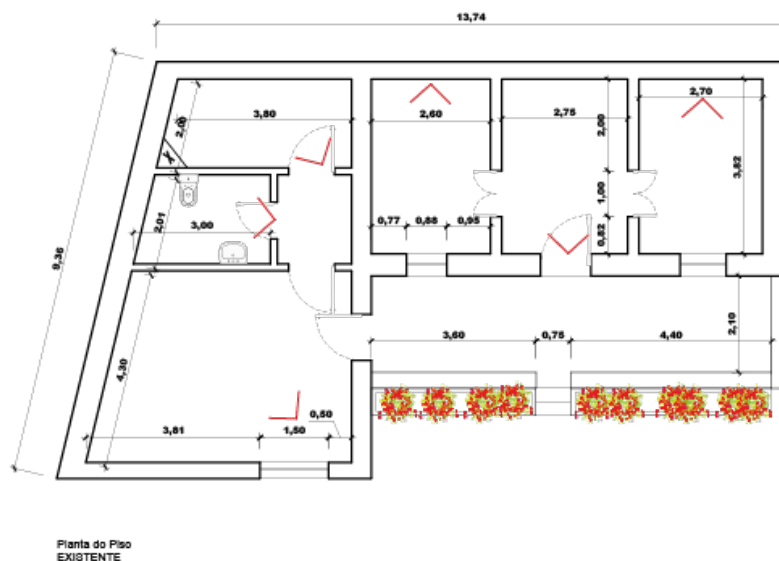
Identificação em planta do levantamento fotográfico com ângulo de visão.
